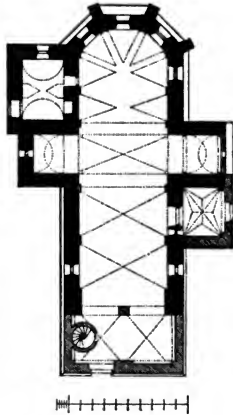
Drahles. Grundriss der Kirche.
